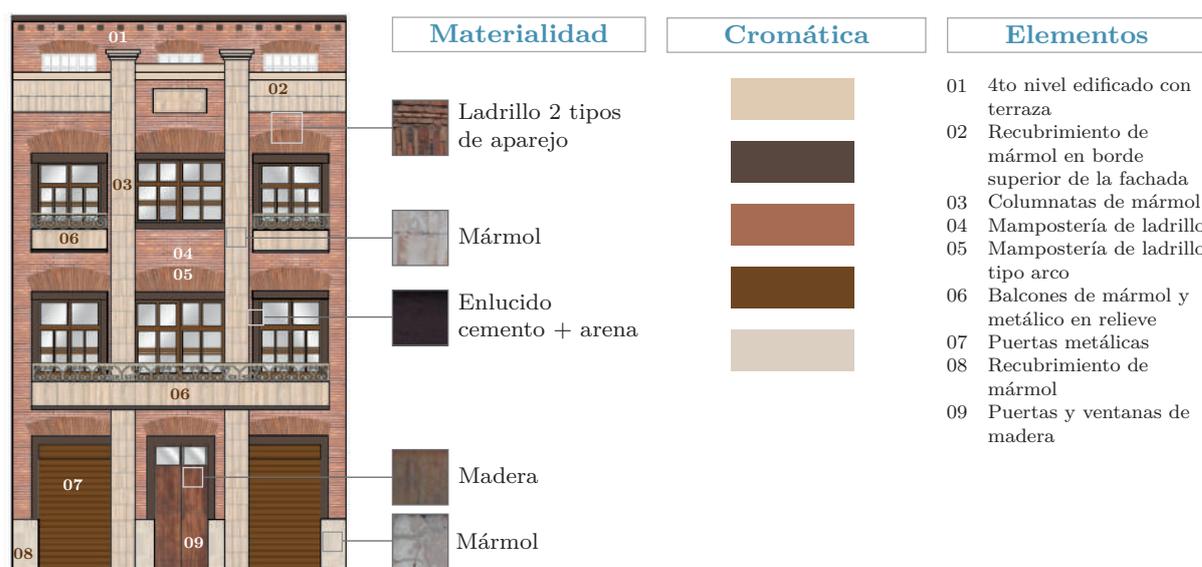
Características de fachada caso de estudio C05. Fuente y elaboración: Autora.
